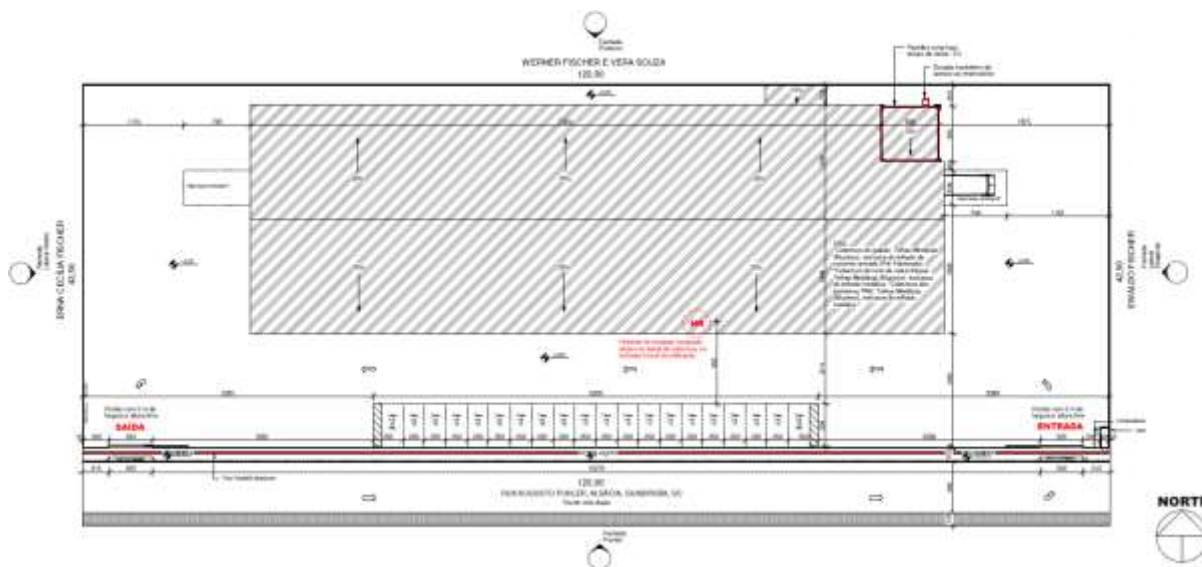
Planta topográfica do imóvel e locação do Galpão.
